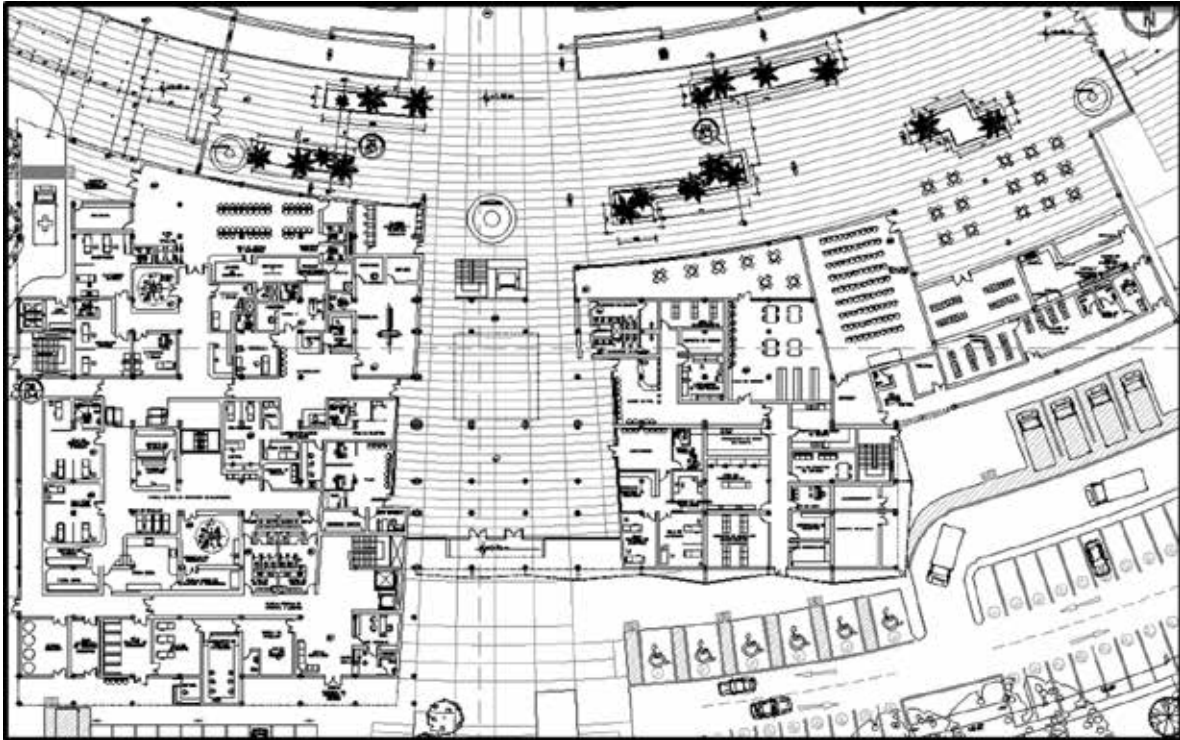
Planta Baja Ala-2 de la Unidad de Caumatología.
